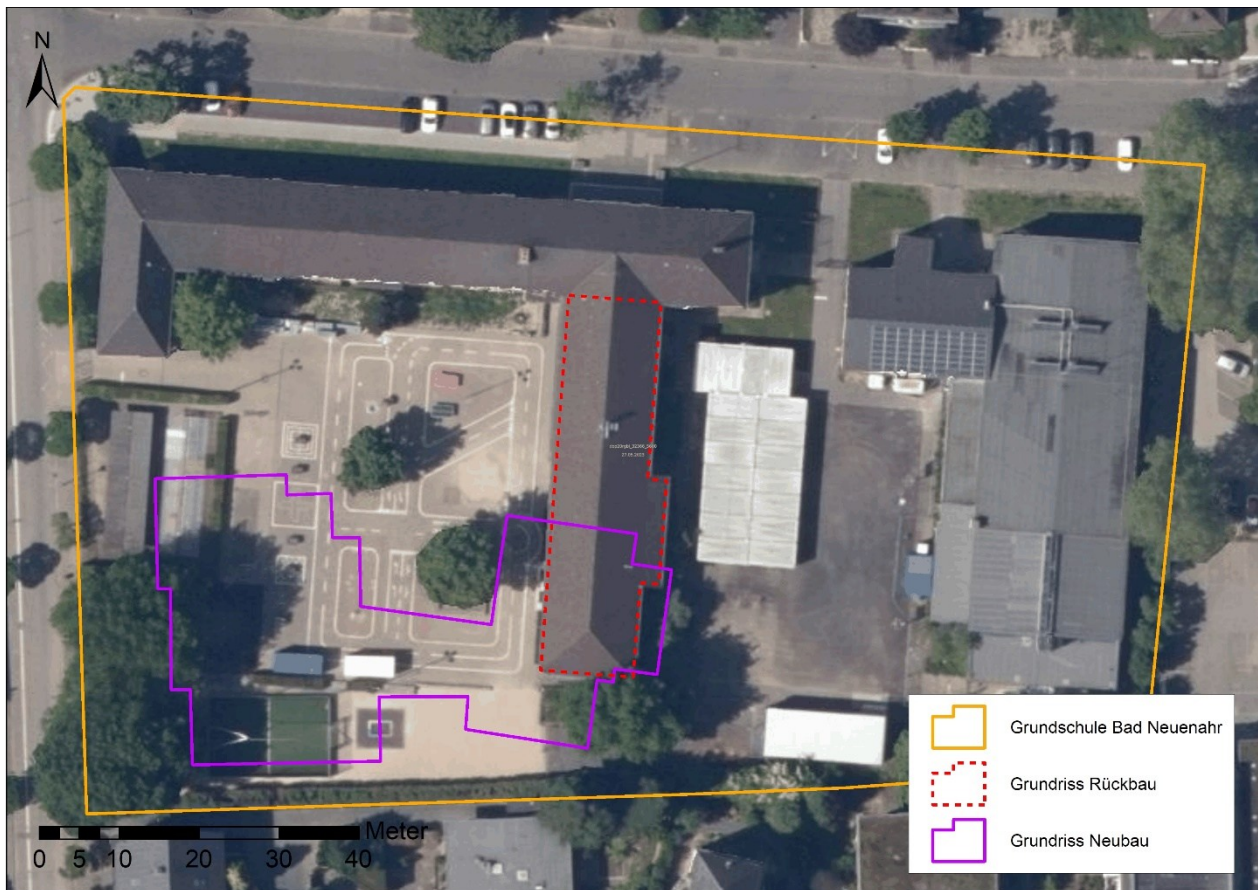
Grundschule mit Grundrissen des Neu- und Rückbaus
